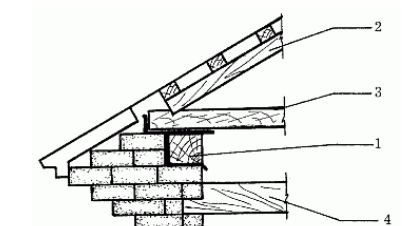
Наслонные стропила в каменных зданиях: 1 – мауэрлат; 2 – стропильная нога; 3 – затяжка; 4 – чердачное перекрытие
